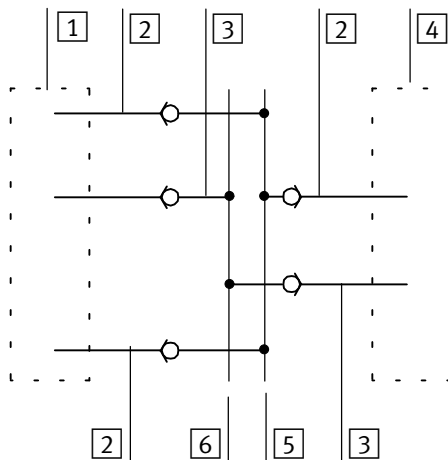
/4: Sammelleitungen mit Rückschlagventilen
